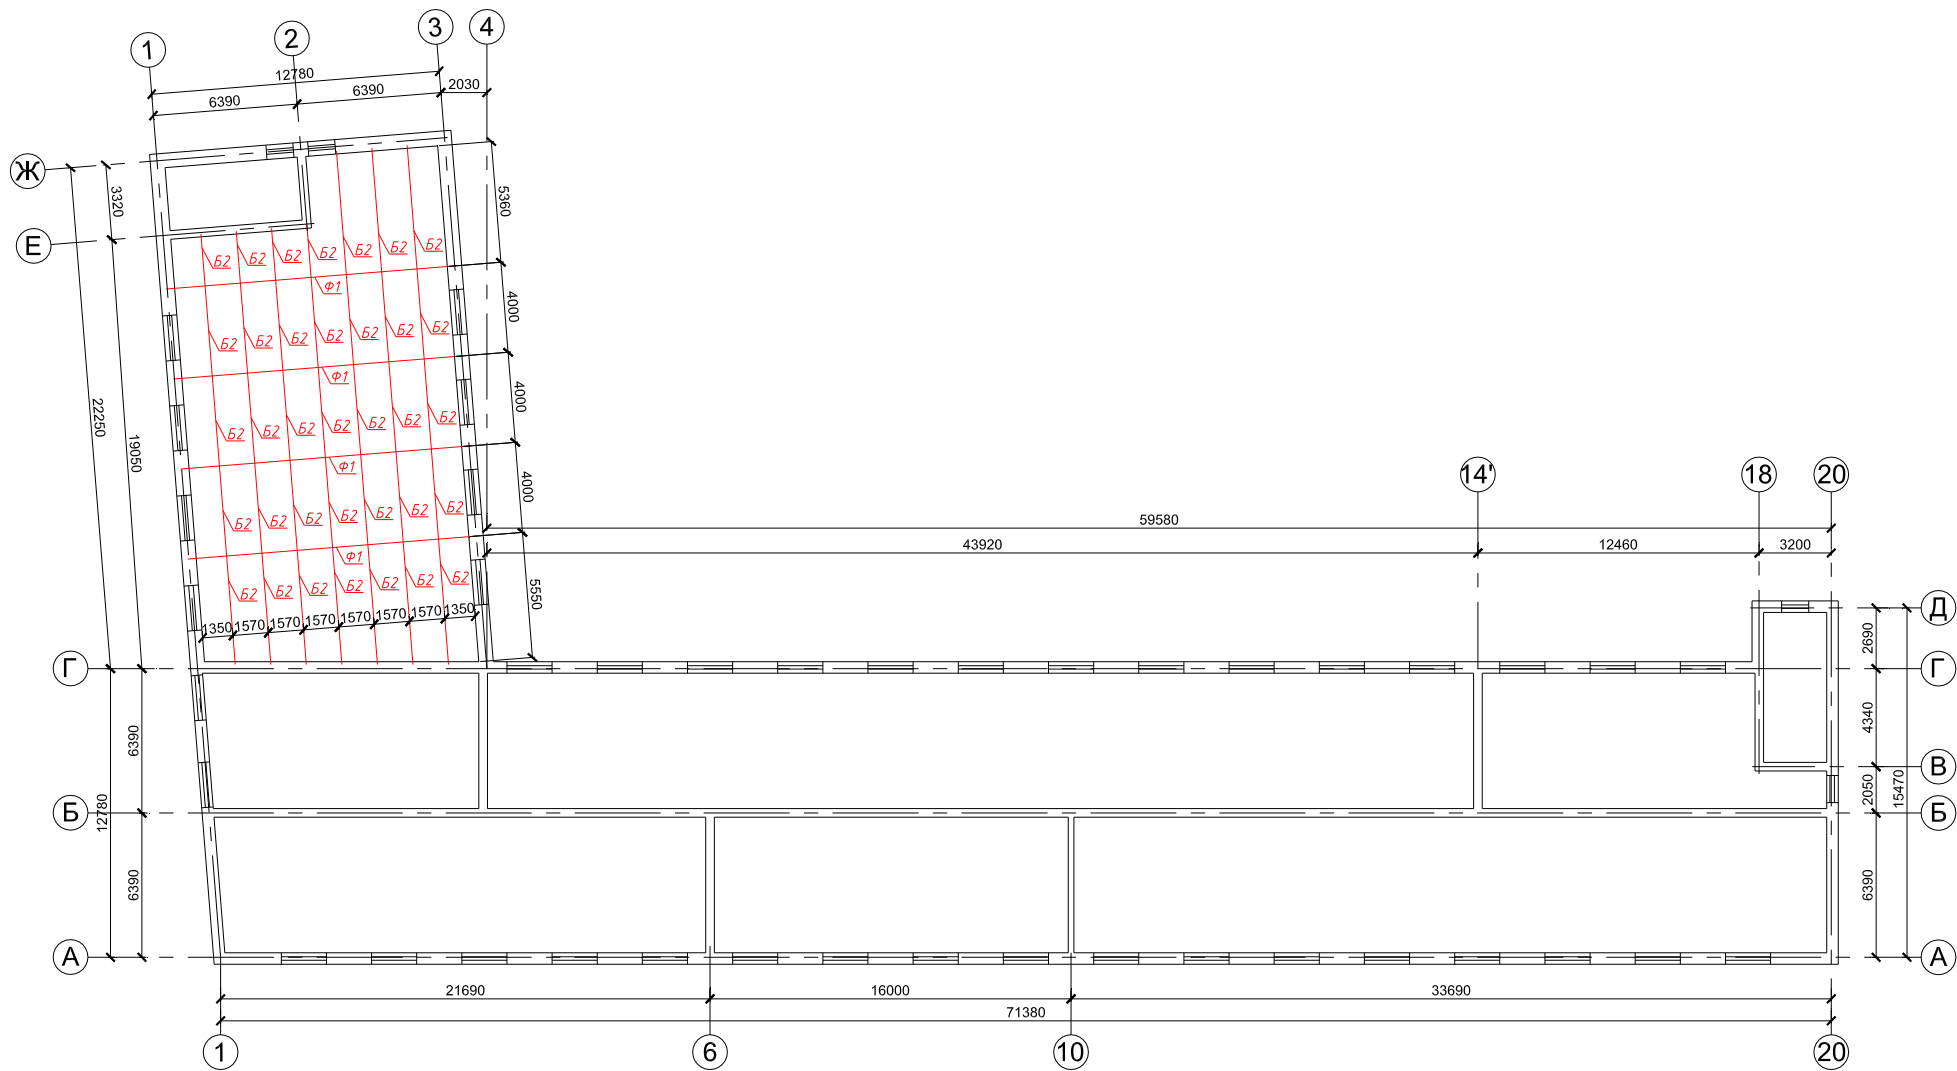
Схема раскладки плит перекрытия над четвертым этажом здания.
